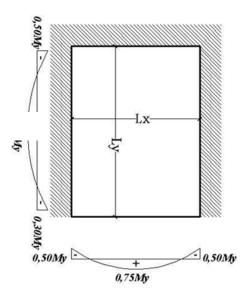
moment d'encastrement de dalle rectangulaire.
